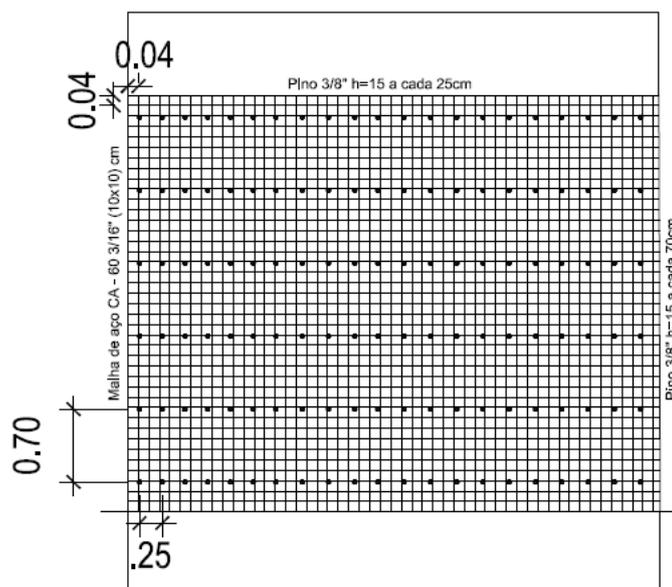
Detalhe construtivo em planta da malha de armação em aço da faixa elevada
